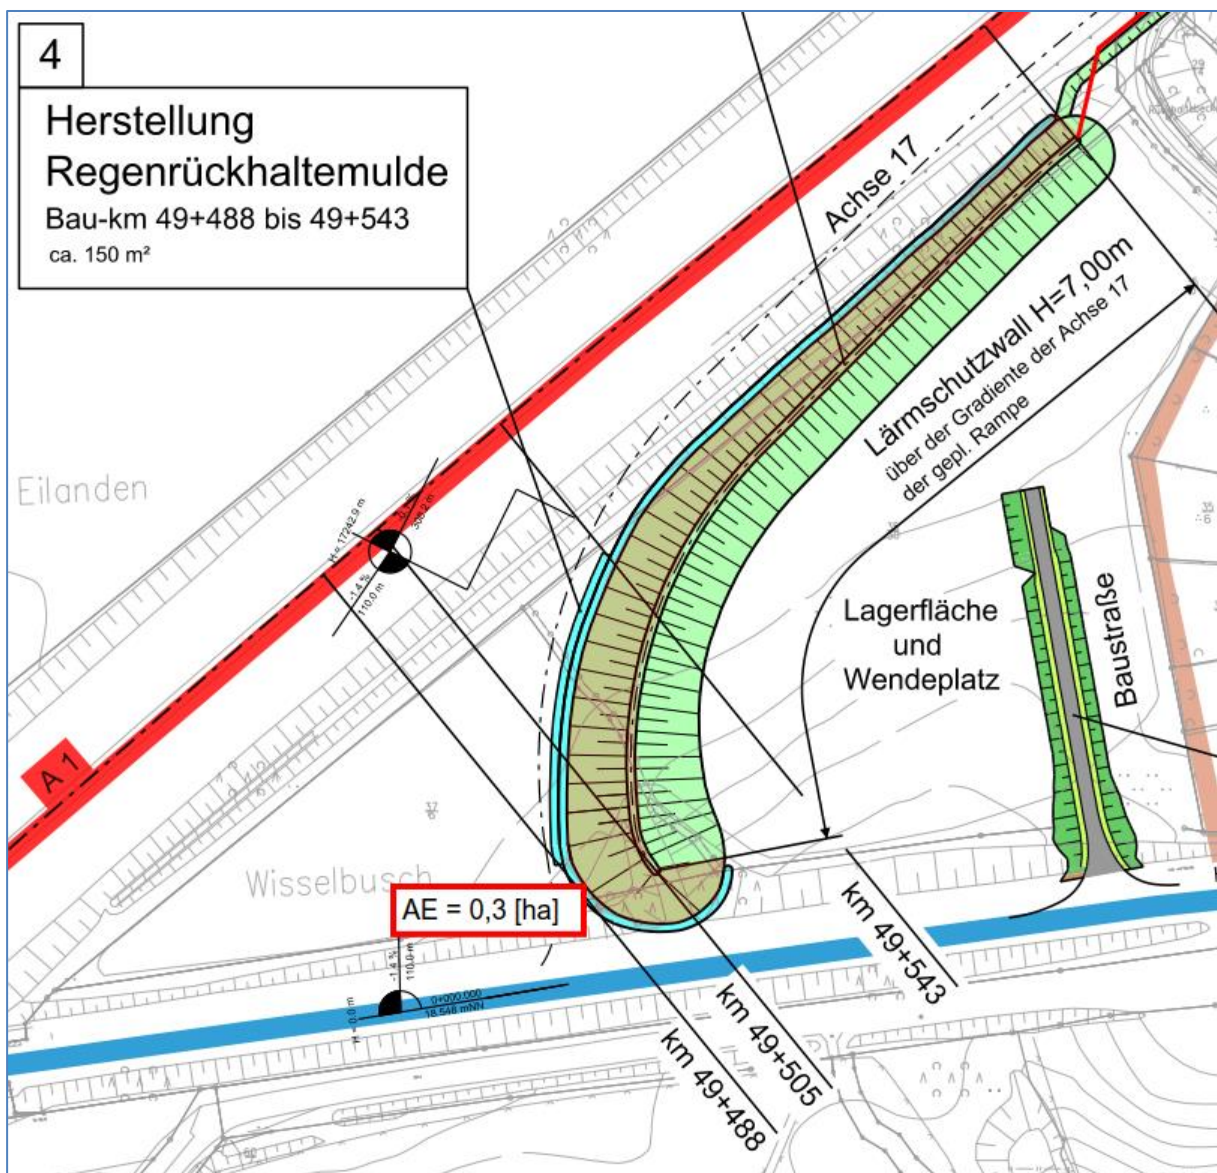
Lageplan mit schematischer Darstellung der Regenrückhalte mulde
